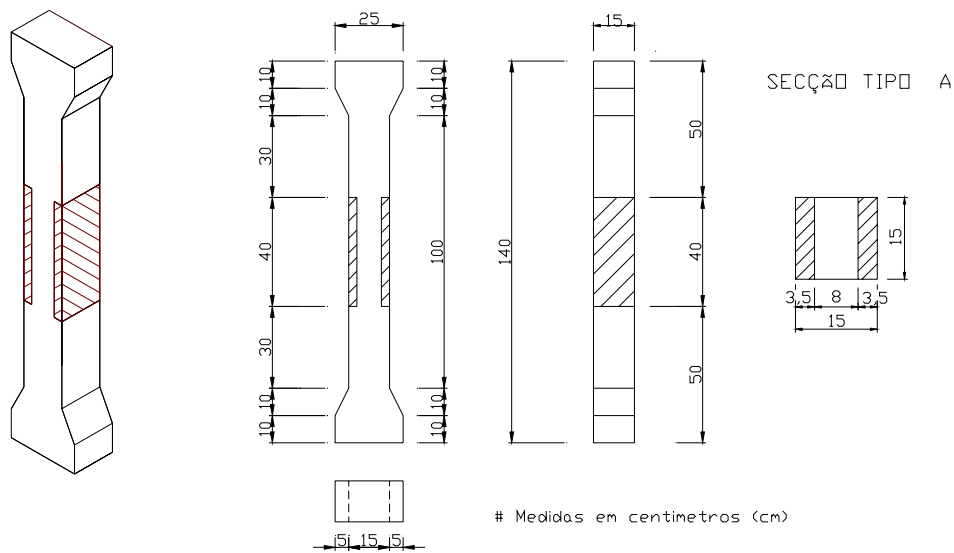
Vista e seção longitudinal do pilar com seção Tipo A.
